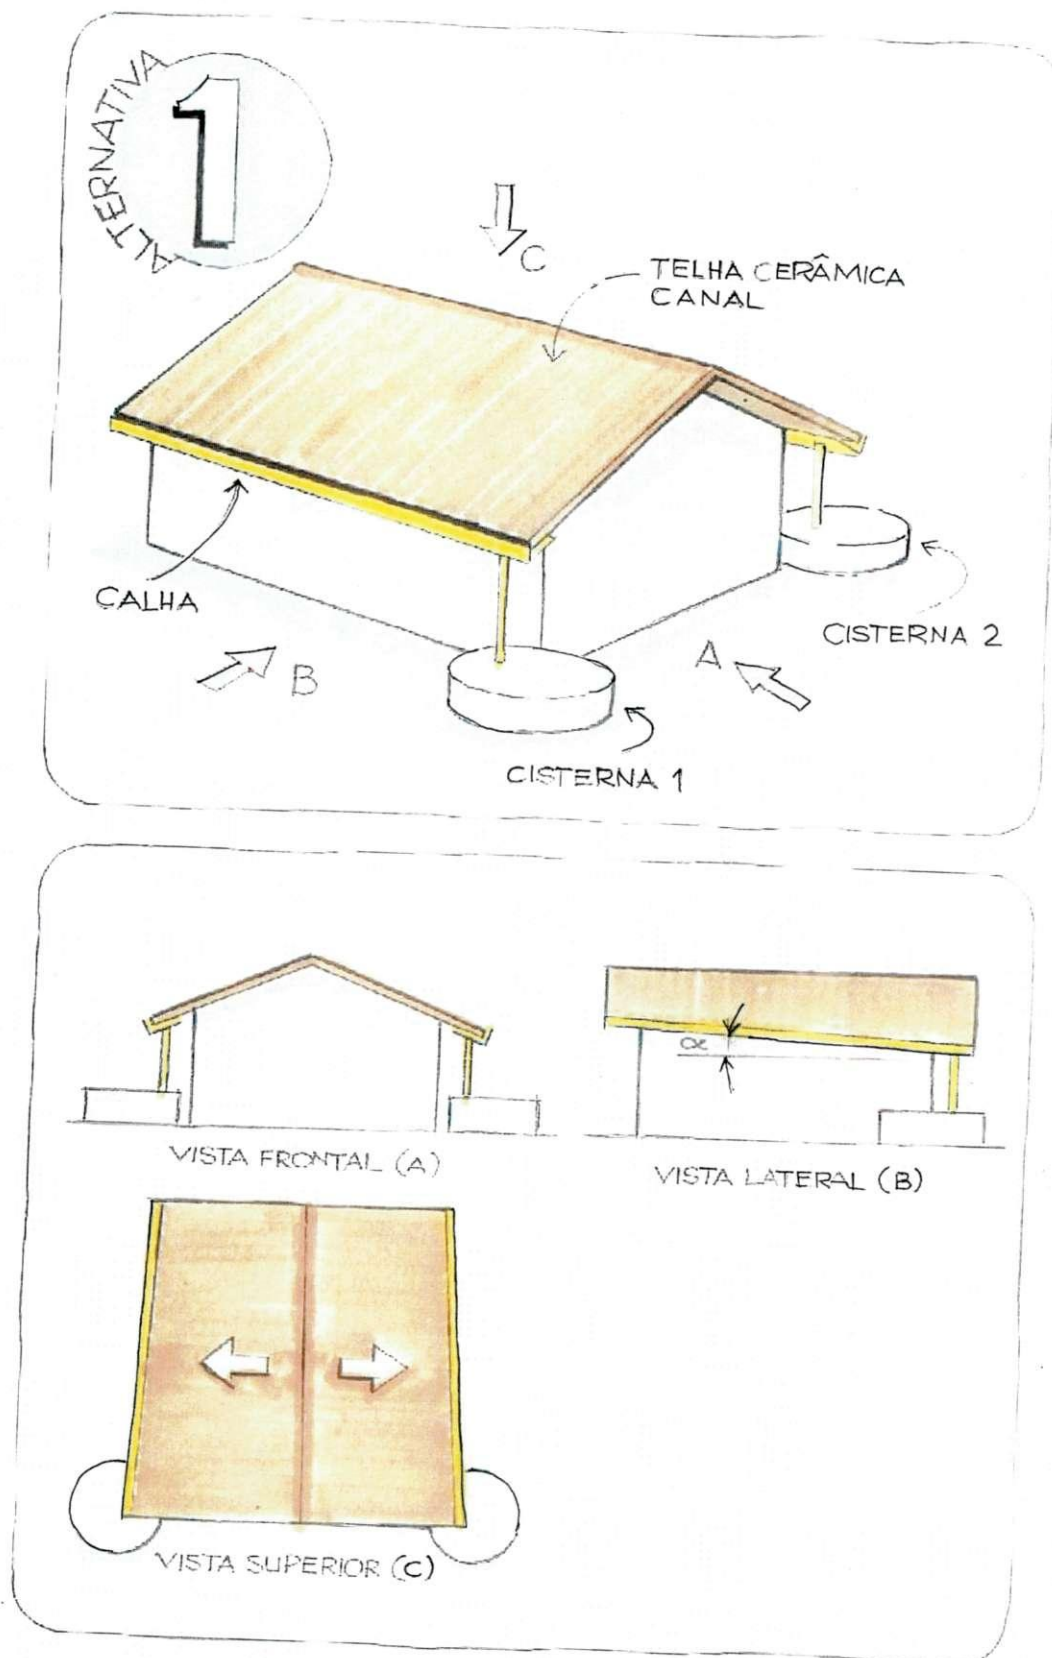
Alternativa 1 apresentada em perspectiva e vistas ortogonais
